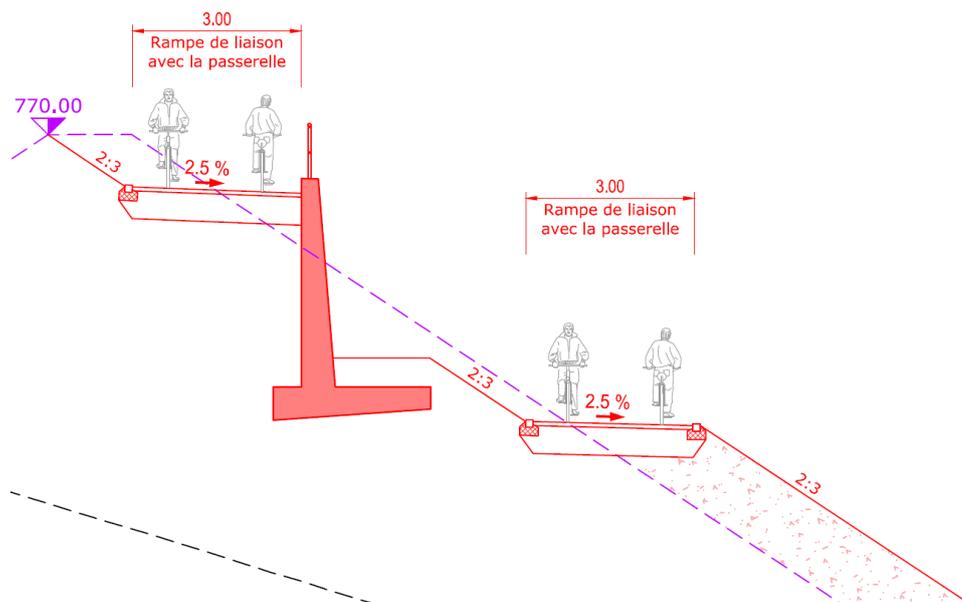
Profil en travers (coupe C-C) de la rampe, avec mur de soutènement entre les deux niveaux. Dans la partie inférieure le talus en remblai se prolonge jusqu'à la RC 601.
